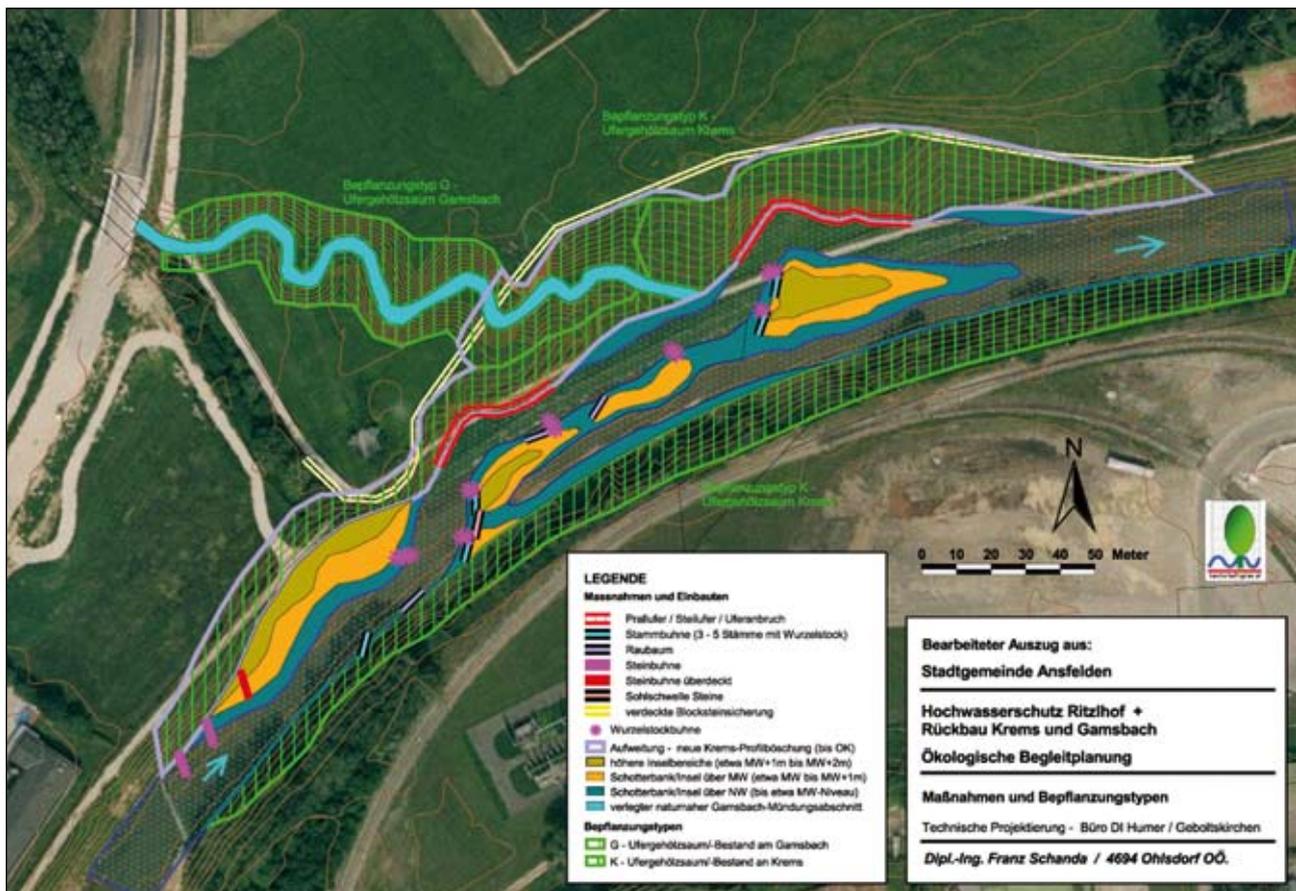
Lageplan des Projekts mit Maßnahmen und Bepflanzungstypen (Bearbeiteter Auszug aus dem Einreichprojekt). Die Bauausführung erfolgte zum Teil etwas davon abweichend. Orthofoto DORIS Land Oö.
